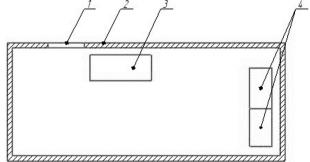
Внутреннее устройство контейнера для слесарно-токарных работ (1— входная дверь; 2— стенка контейнера; 3— рабочий стол; 4— места хранения слесарно-токарного оборудования)
